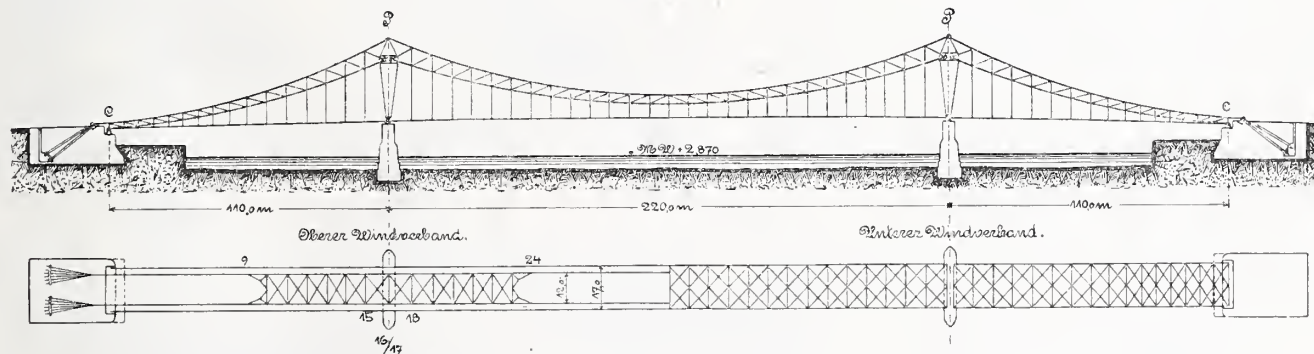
Schematische Darstellung der Hauptträger. — Aufriss und Grundriss. — Masstab 1:3000.
